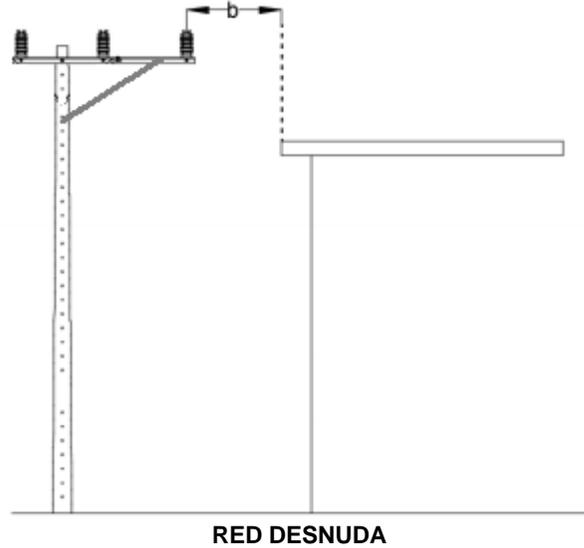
Distancia horizontal entre la red eléctrica con conductores desnudos y la proyección de una edificación por debajo de la red, caso B.
